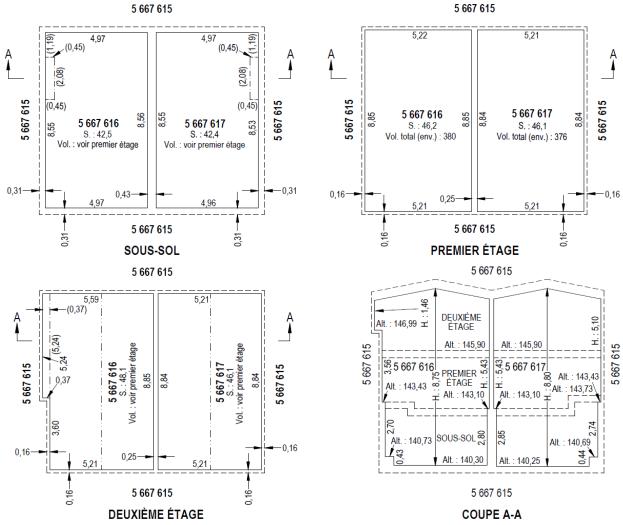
Vue d'étage et vue de coupe — Planchers de type privatif
